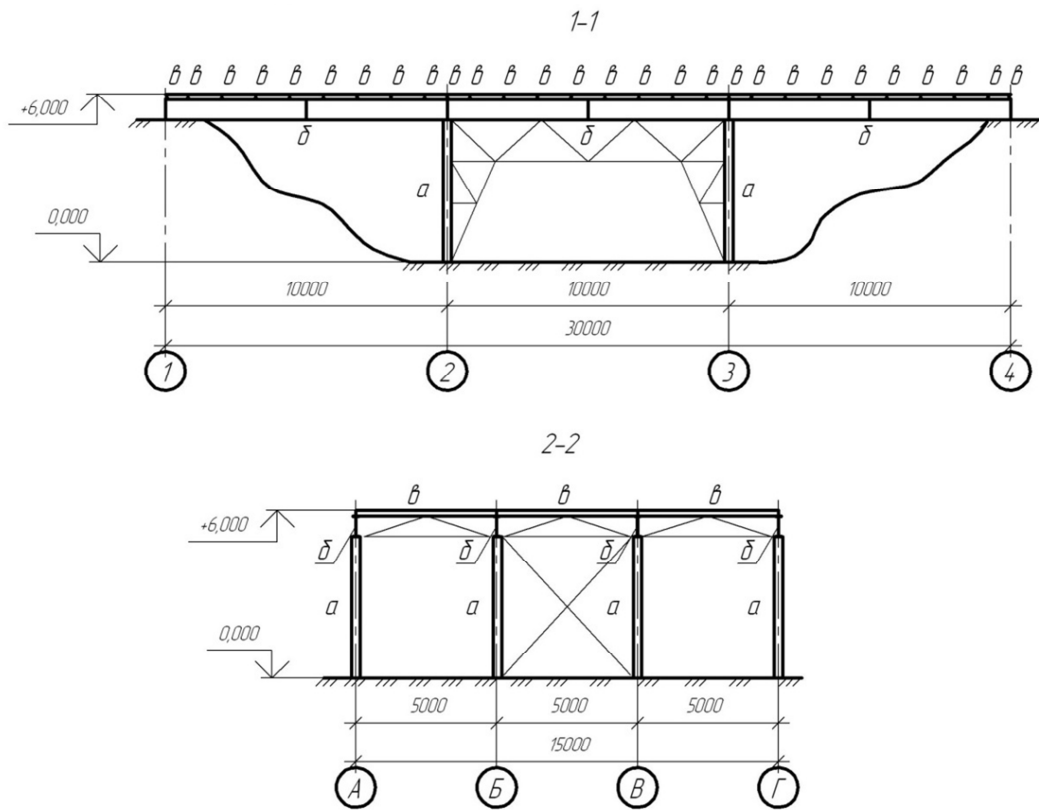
Продольный и поперечный разрезы: а – колонны; б – главные балки; в – второстепенные балки
